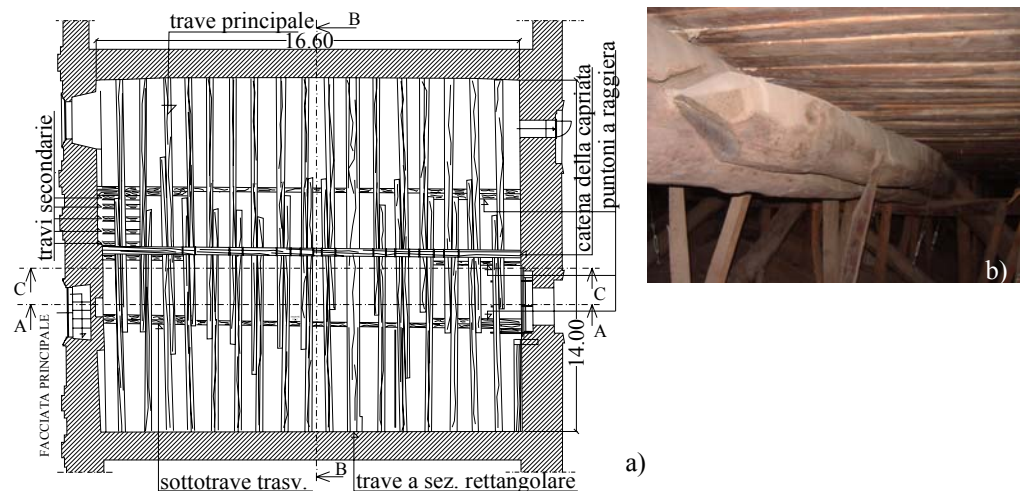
Struttura del solaio: a) Carpenteria; b) Particolare sovrapposizione trave; c) Sezioni; d) Sistema di irrigidimento longitudinale; e) Sistema di irrigidimento trasversale. (continua)
